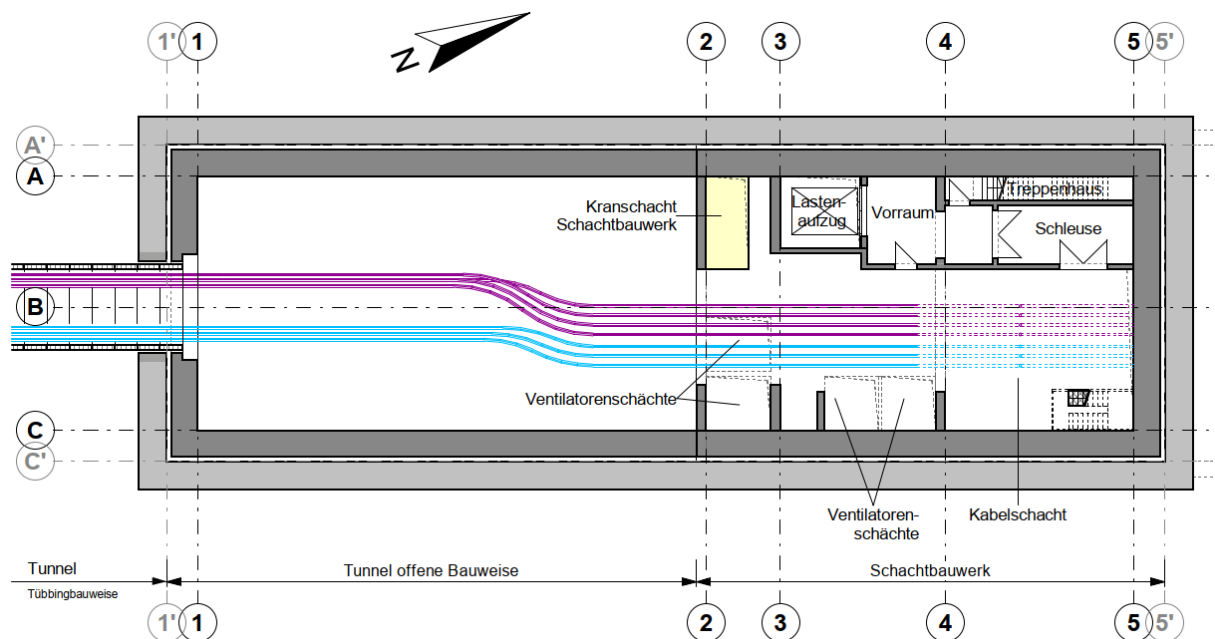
Grundriss Schachtbauwerk SH und Tunnel offene Bauweise; 4. Untergeschoss
